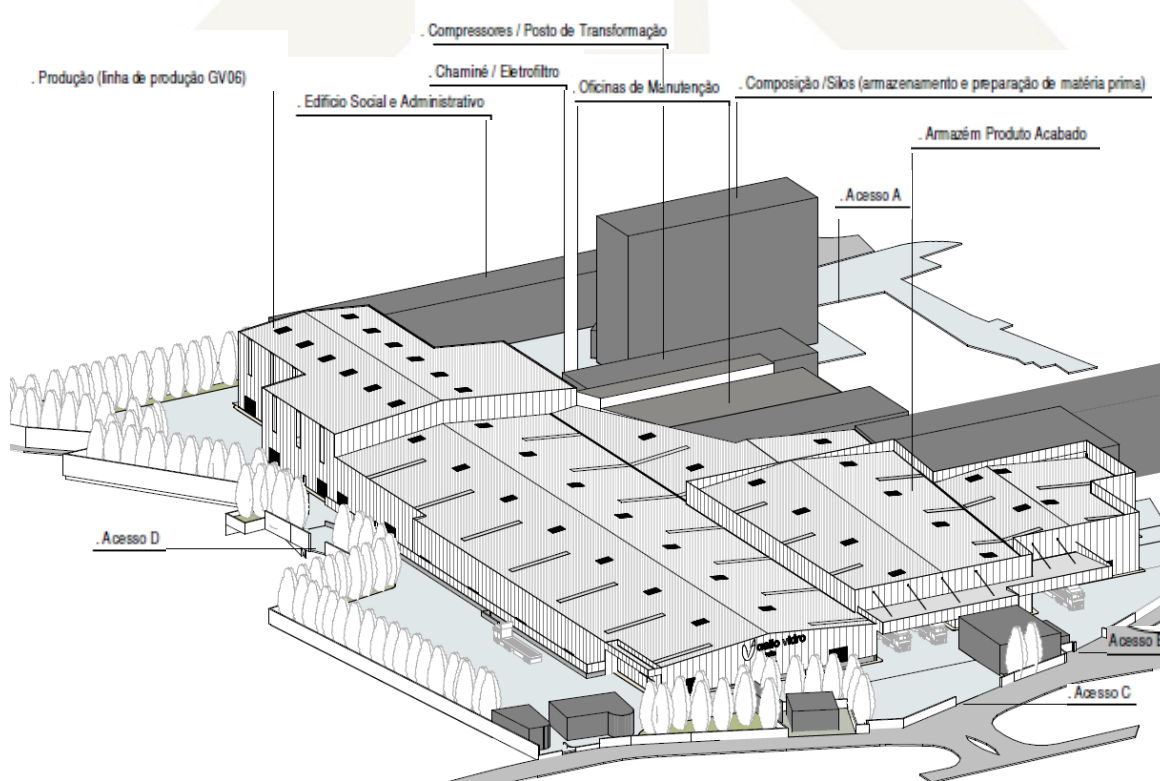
Planta 3D de implantação das instalações da GALLOVIDRO
